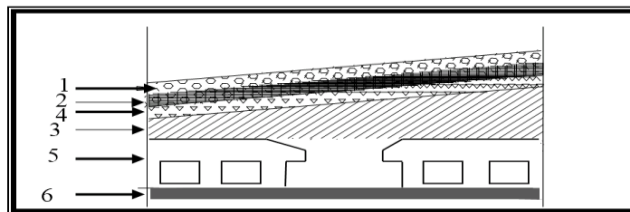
Disposition des matériaux pour plancher a corps creux (terrasse)
